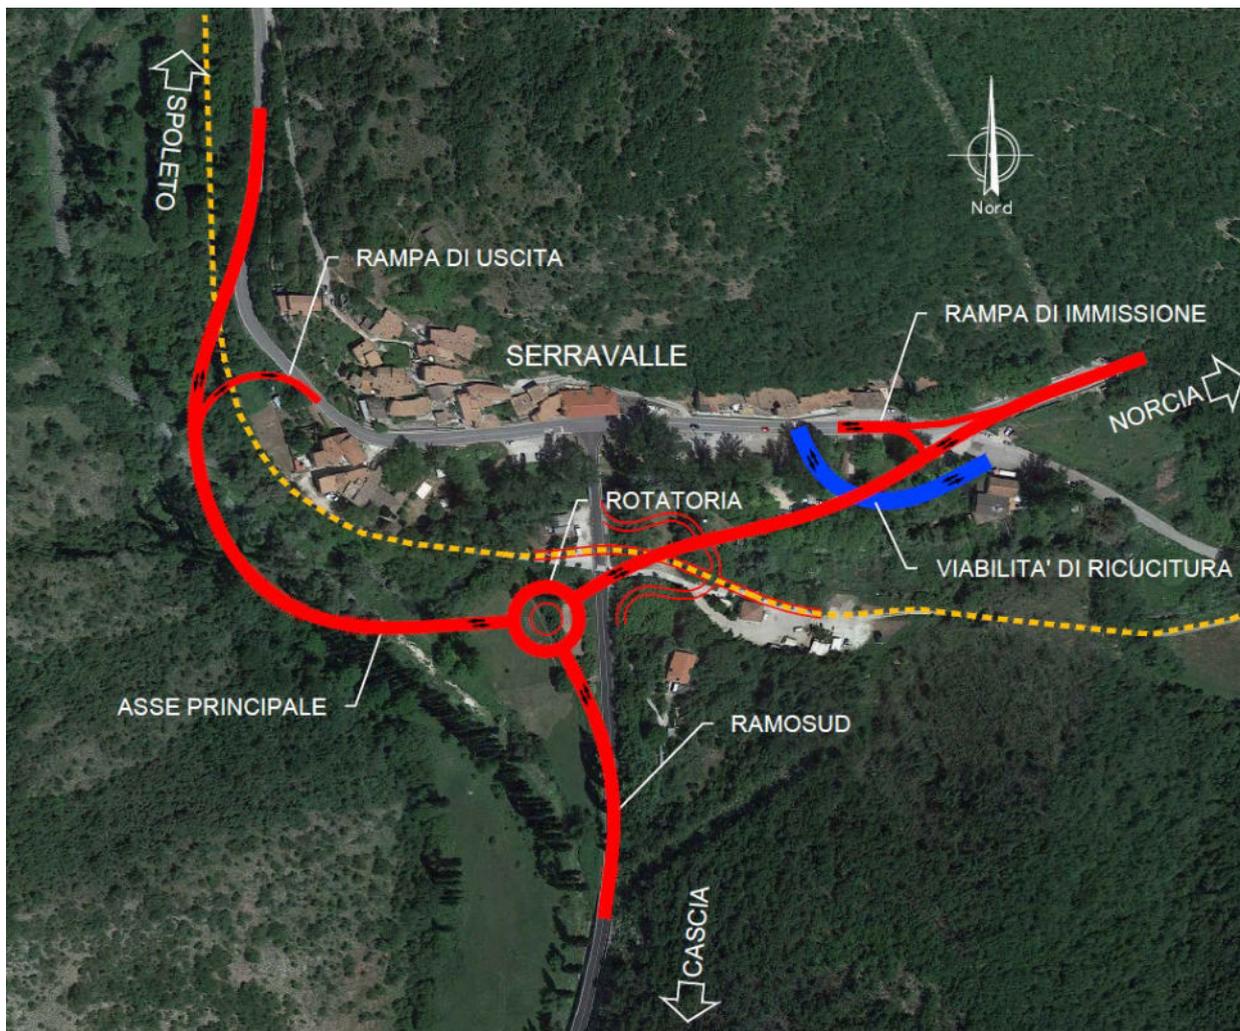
Planimetria di progetto Alternativa1- variante completa
